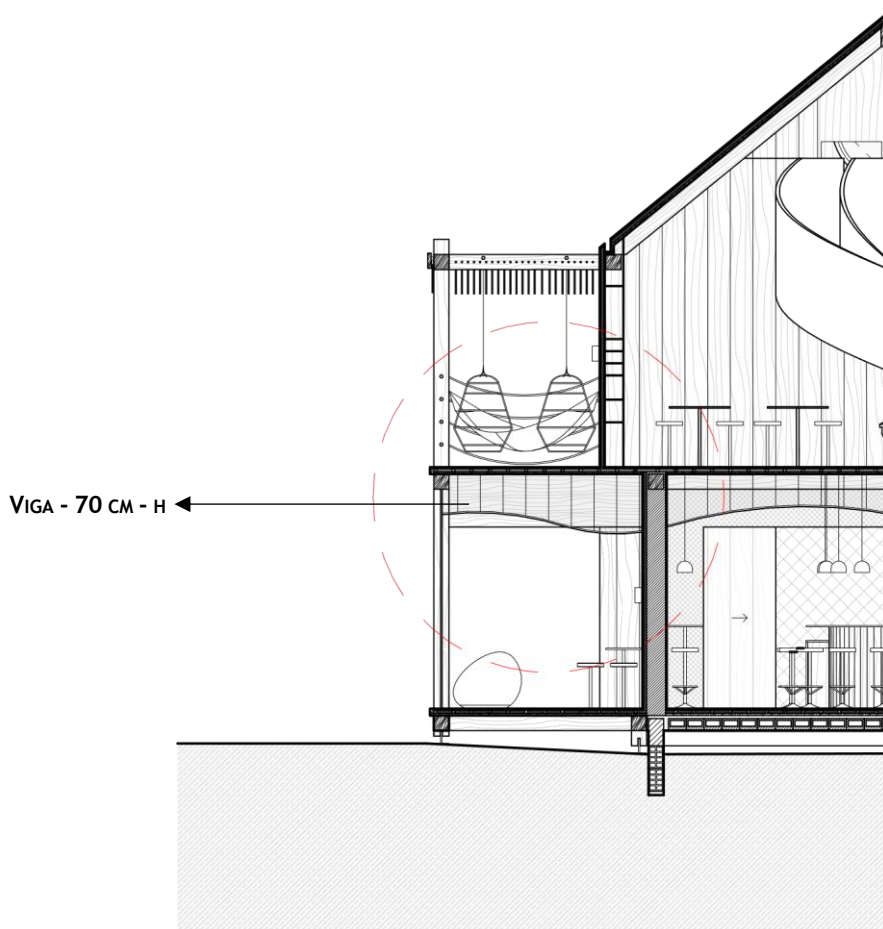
CORTE EXPLICATIVO DA RESTRUTURAÇÃO DA PAREDE SUPERIOR | 1/200
